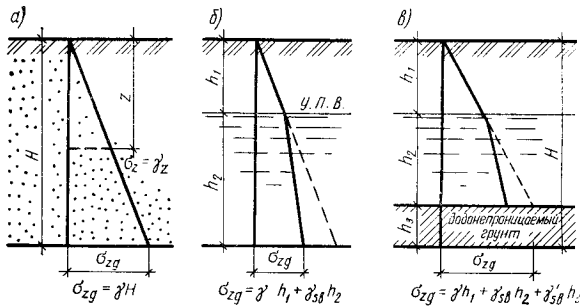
Эпюры вертикальных напряжений от собственного веса грунта:
